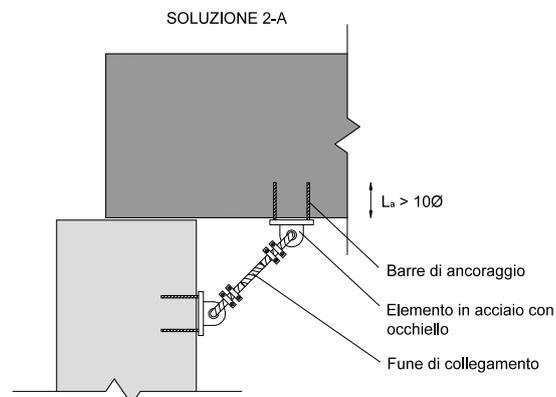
Intervento su connessione trave-pilastro mediante fune di collegamento
